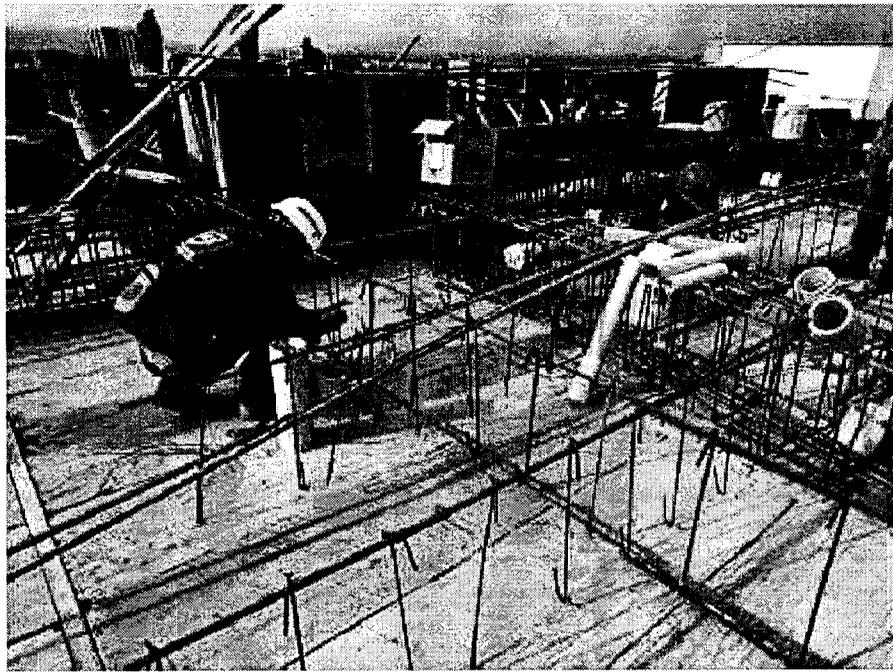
Instalación conexiones hidrosanitarias en vigas y viguetas ejes (H-L) – Torre B.
